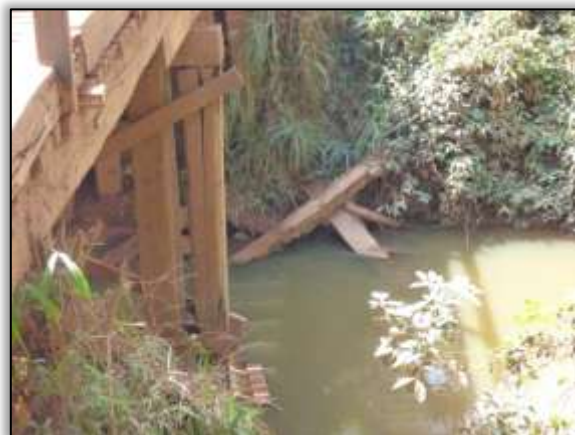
Ponto 16 – Montante – Toras de madeira dentro do igarapé.
